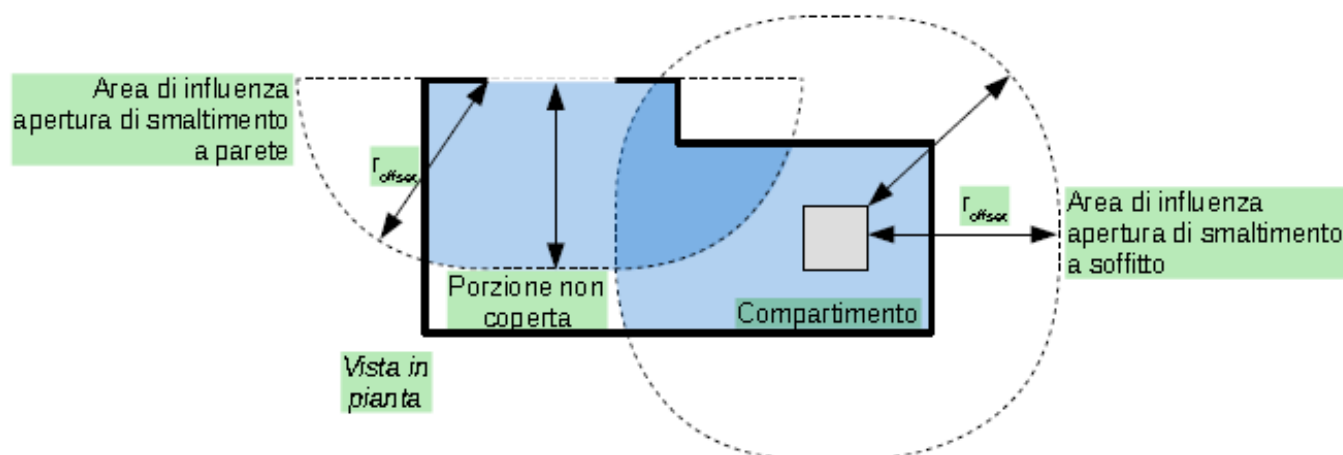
Verifica dell'uniforme distribuzione in pianta delle aperture di smaltimento
